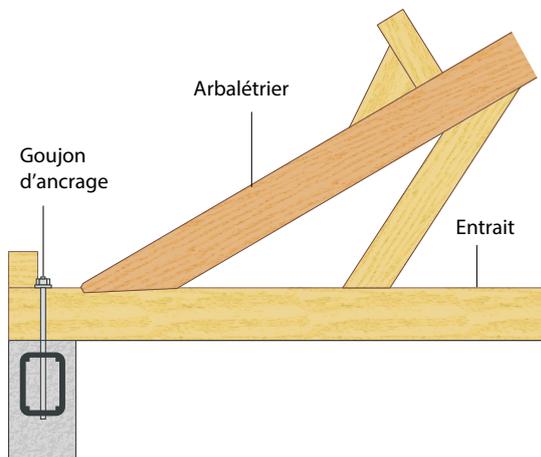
Exemple d'assemblage entre structure et charpente (1)
